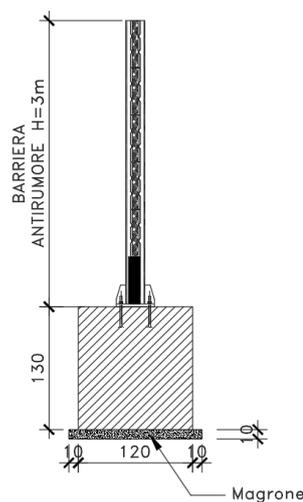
Sezione trasversale strutture di mitigazione acustica e opere di fondazione.
